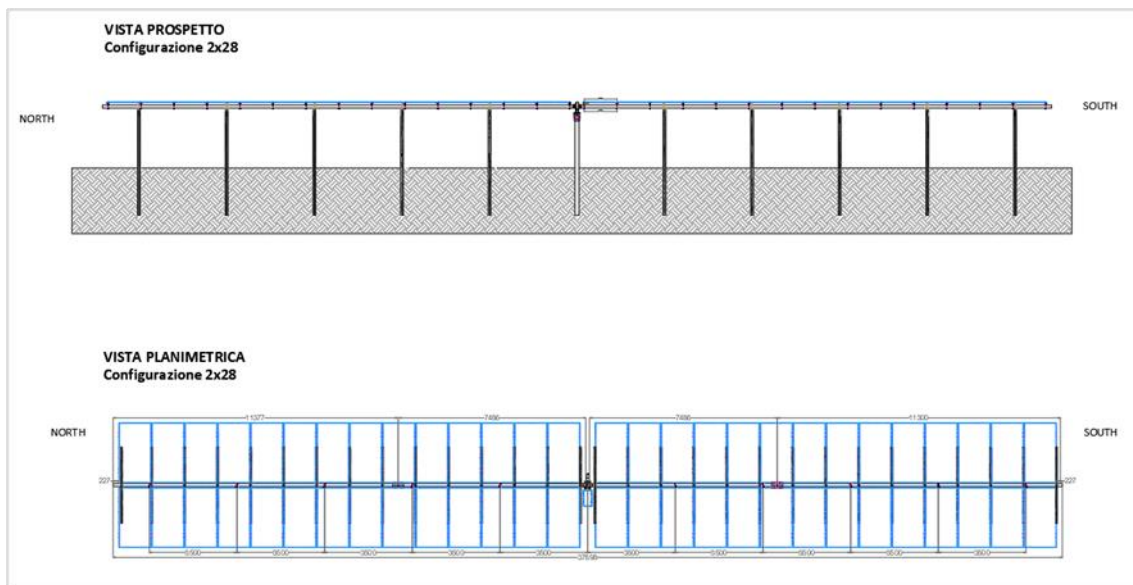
Vista prospettica e planimetrica delle strutture porta-moduli tracker 2x26
